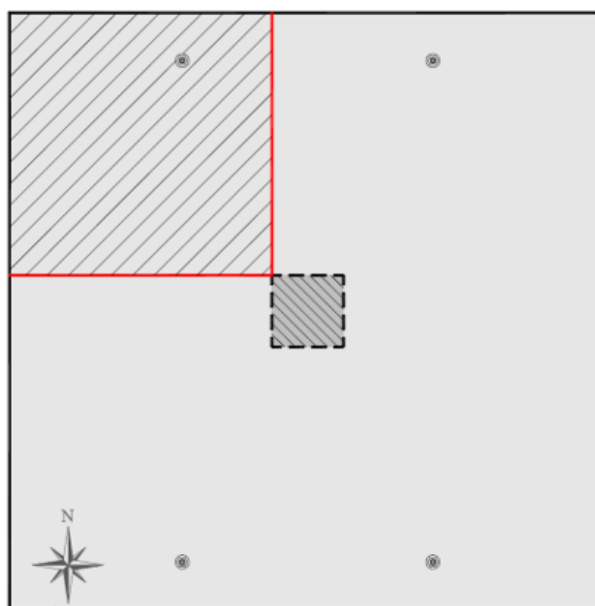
Posição do corte no quadrante Noroeste da laje
